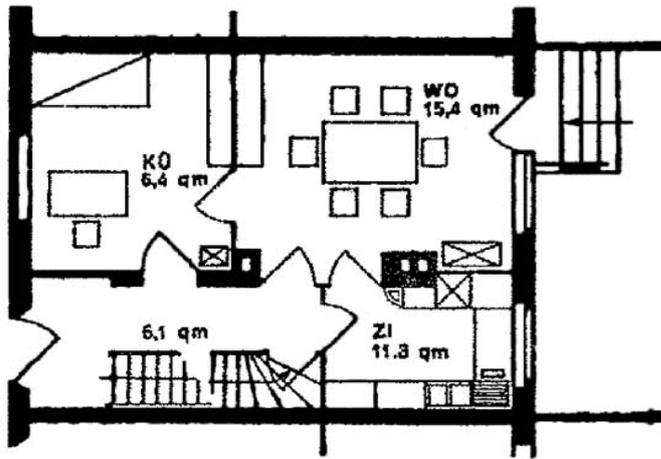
Planta de uma casa em Kurhessenstrasse, Frankfurt 1928. Plano da “Cozinha Frankfurt” indicando as suas características de poupança de trabalho, 1927
